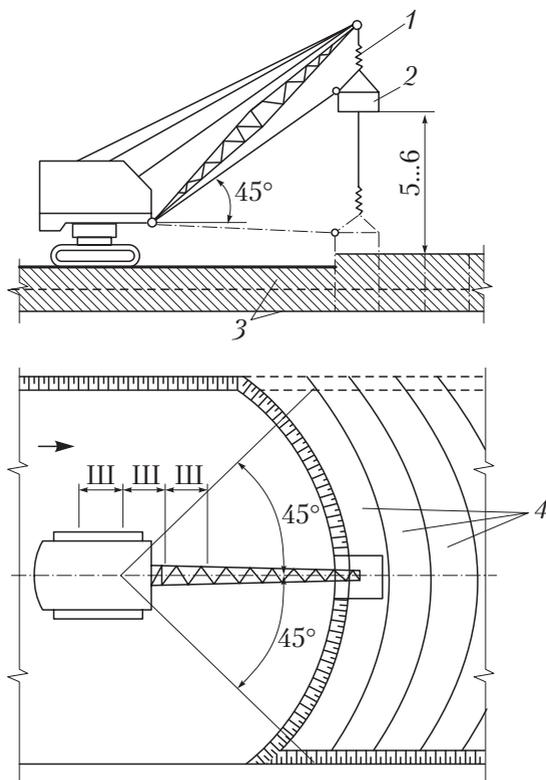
Уплотнение грунта трамбованием плиты, подвешенной к стреле экскаватора:
